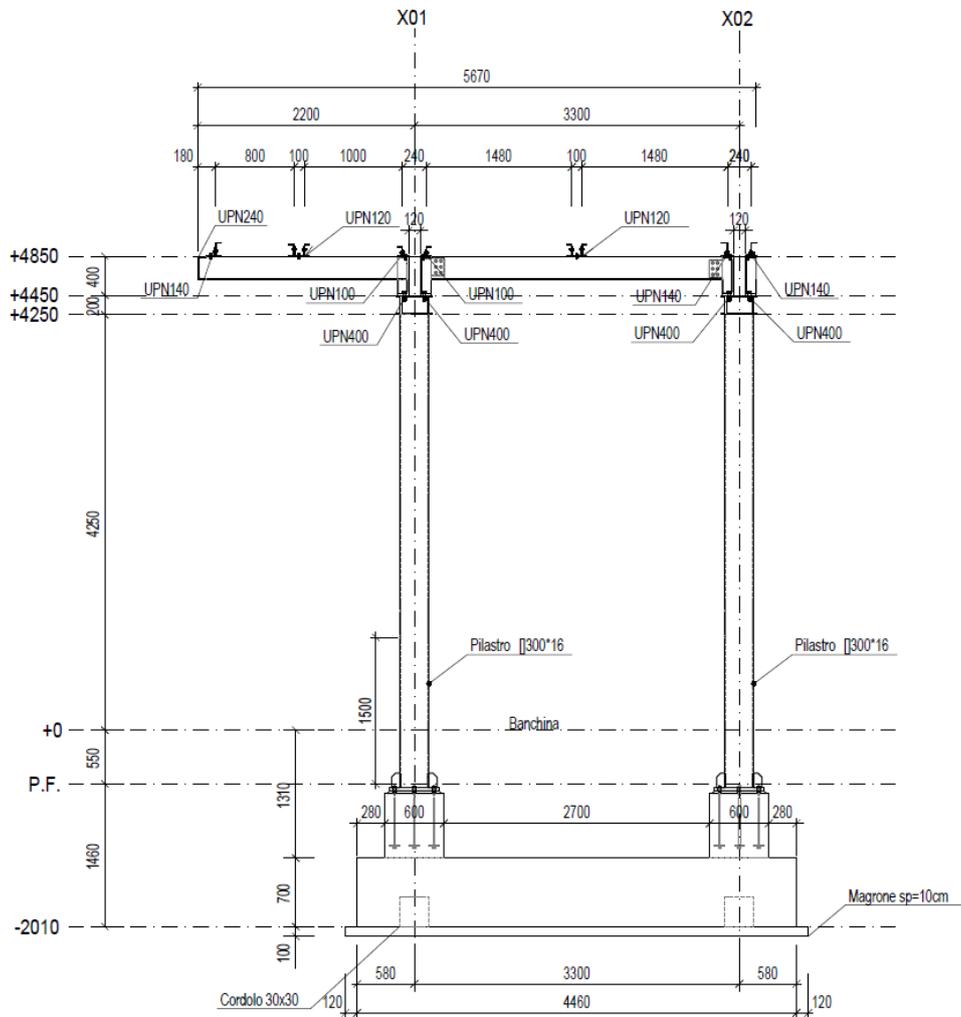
Pensiline – Sezione trasversale della pensilina a singola falda – Pensilina Nord
